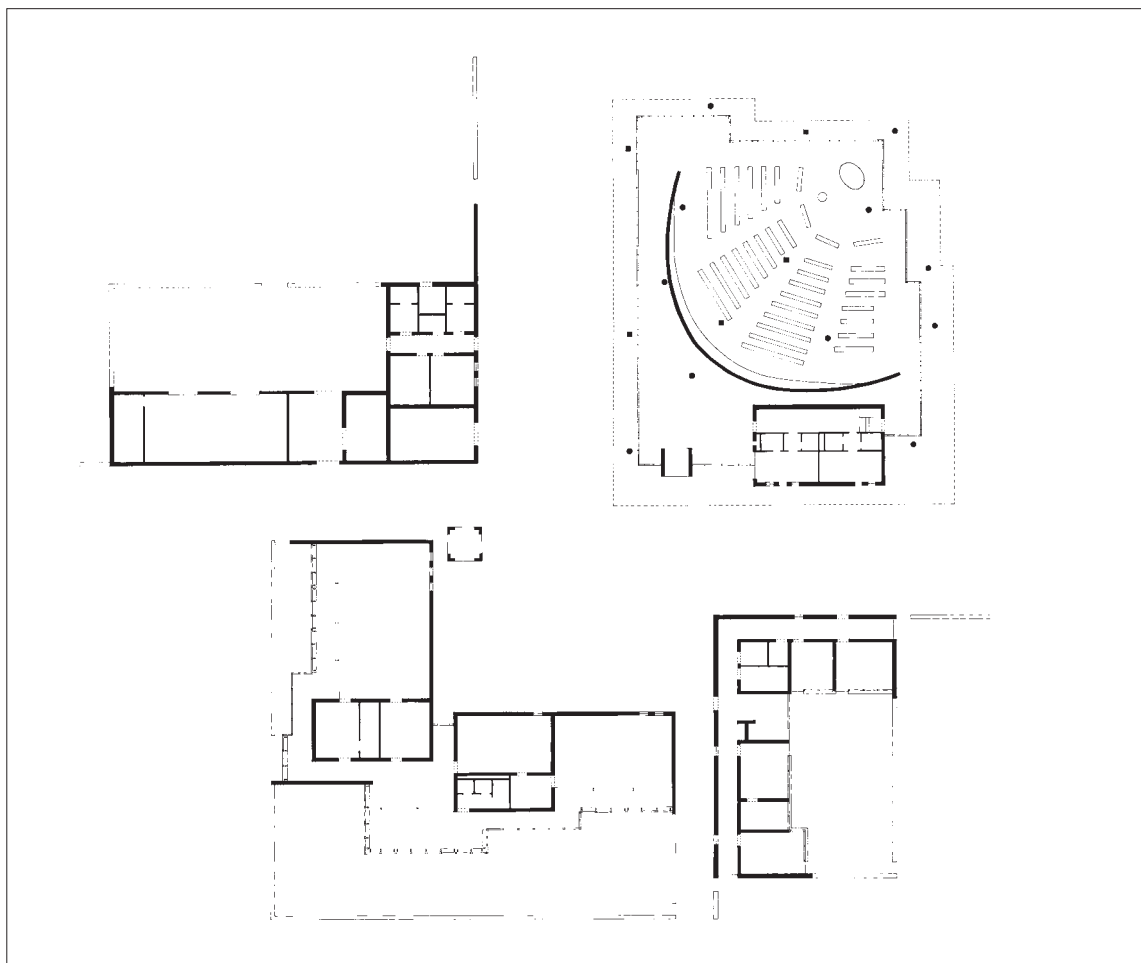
Plan af kirken og tilhørende bygninger. 1:600. Tegnet af MN 2006 efter tegnestuen Birch og Svenning 1996. – *Ground plan and situation plan.
